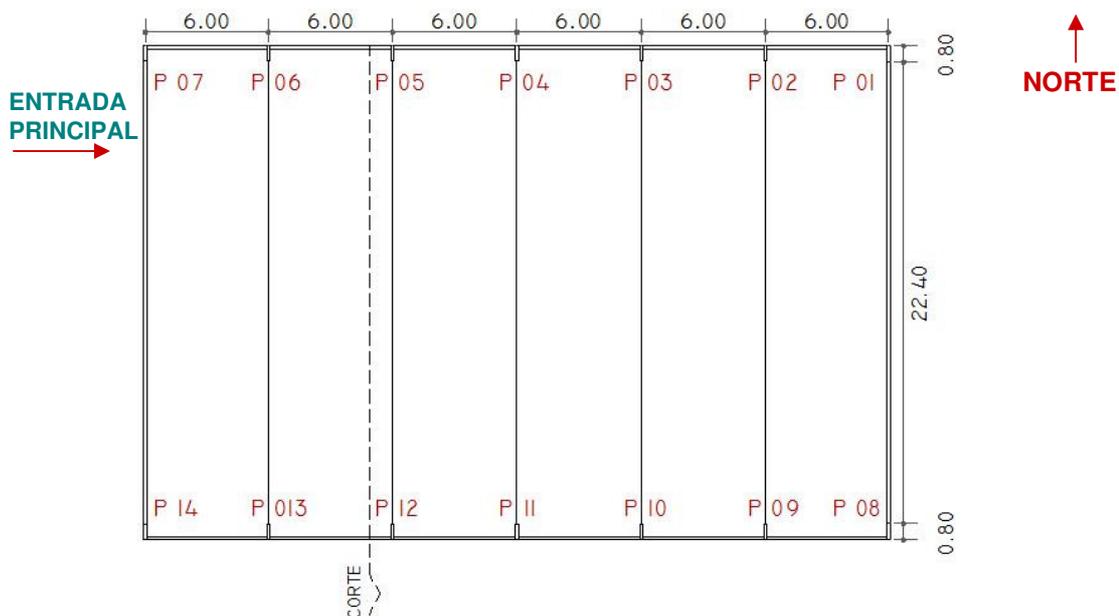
A. Planta com mapeamento dos pilares - Ginásio de Esportes da Escola Estadual
